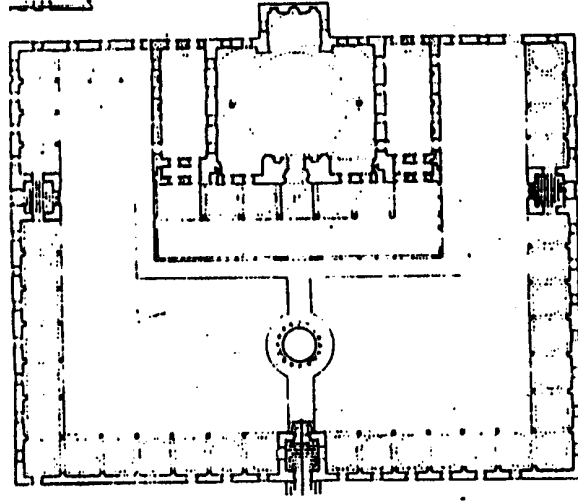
مسقط أفقي لجامع اوج شرقلي في ادرنه
